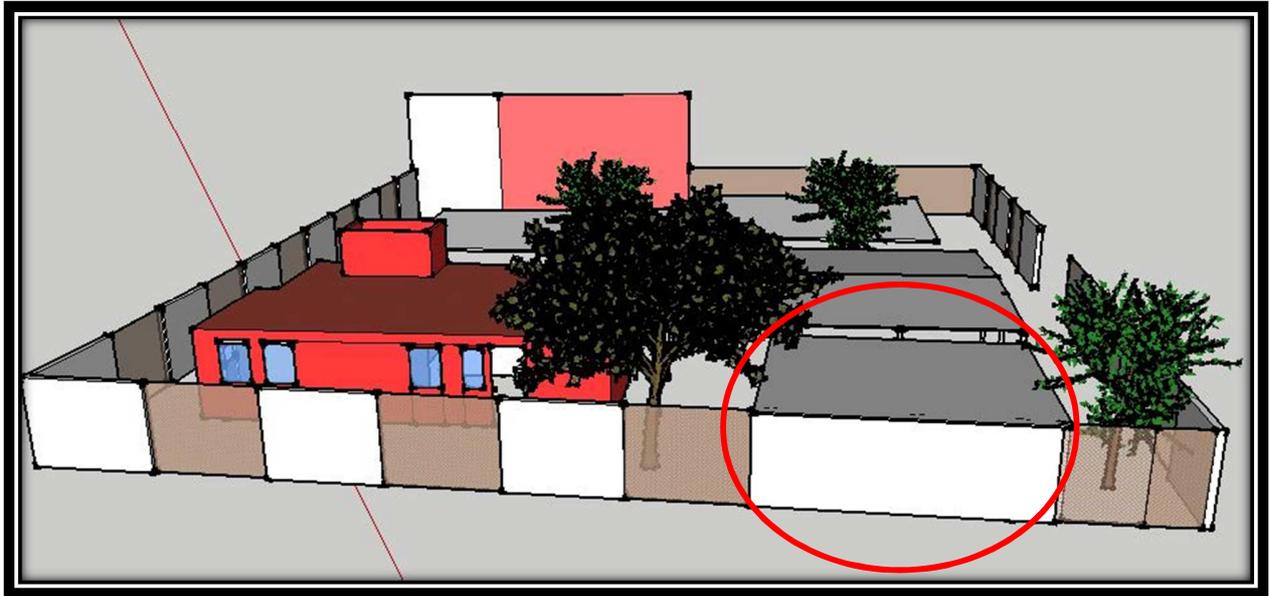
Vista poniente, área de muro piloto. Fuente Archivo Personal.
